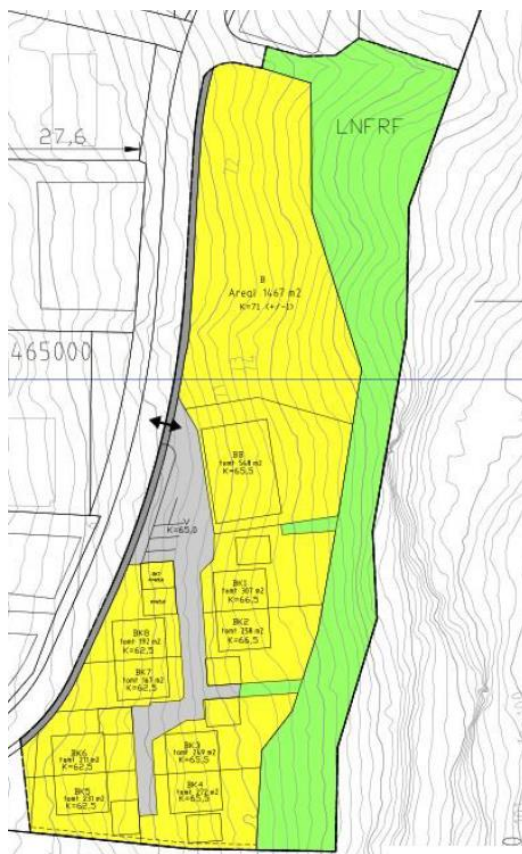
Utgått plankart, revidert 13.02.2014.
